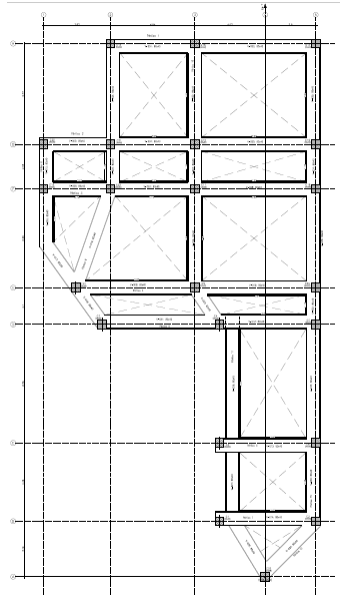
Planta Cimentación Colegio. CAJAMAG.
